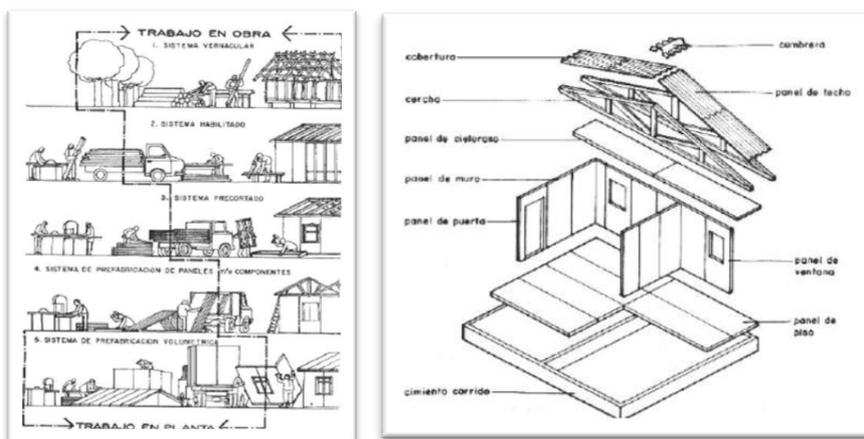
a) Tipos de sistemas constructivos con madera; b) sistema de prefabricación con tableros.
